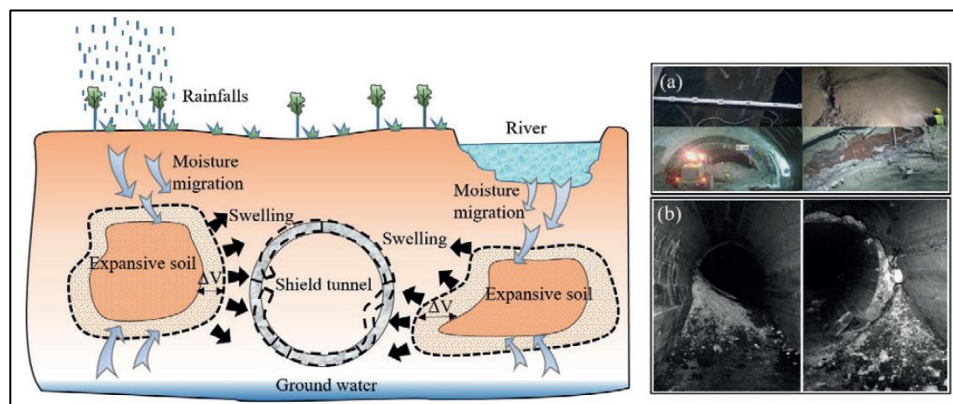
Fenómeno de Swelling afectando a túneles (Yan et al., 2019).
